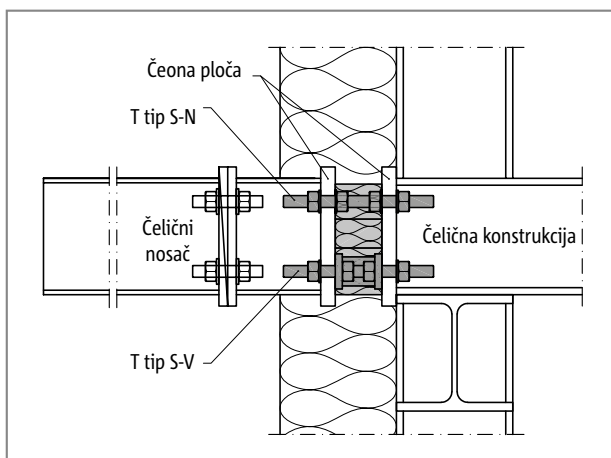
Schöck Isokorb® T tip S-V: poduprta čelična konstrukcija
